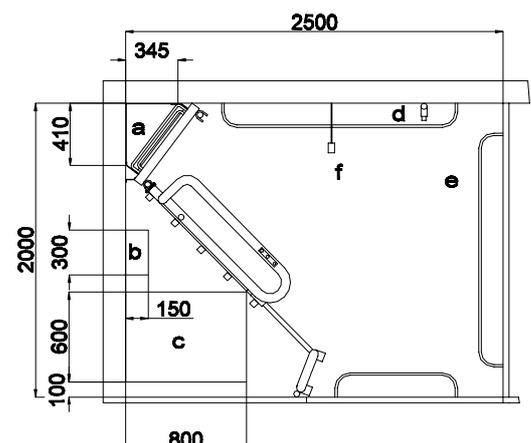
Grundriss einer Bucht in Stallabteil A₃, Bewegungsbucht mit der Möglichkeit der Fixierung der Sau (Maßangaben in mm).
